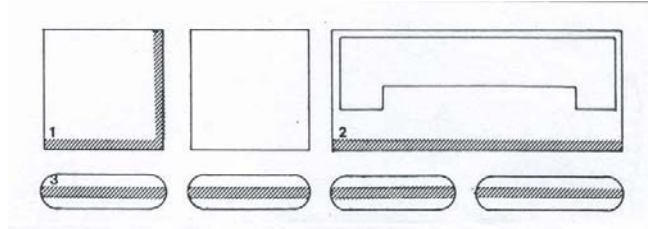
1.- Zanjas bajo veredas, 2.- Sector de estacionamiento, 3.- Bandejones de calles.
